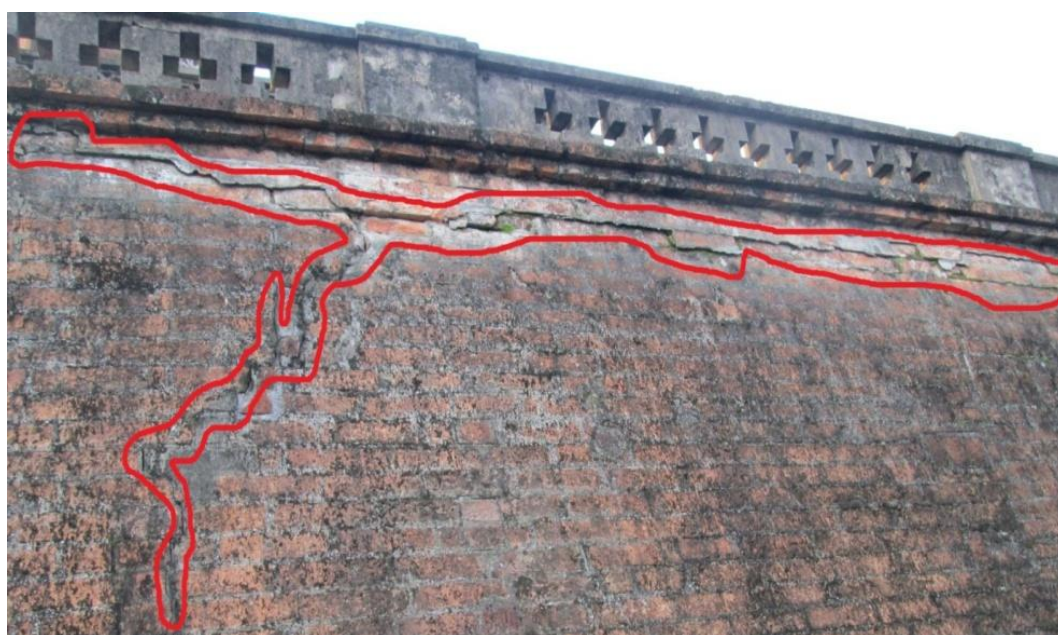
Образование трещин на северном фасаде первого этажа Ханойской Флаговой башни (Ханой-2016)
